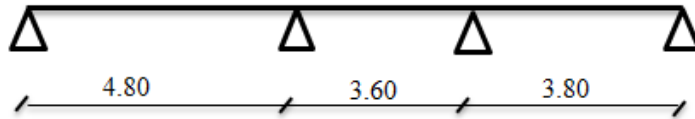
Poutrelle type 05 (Plancher terrasse inaccessible)
